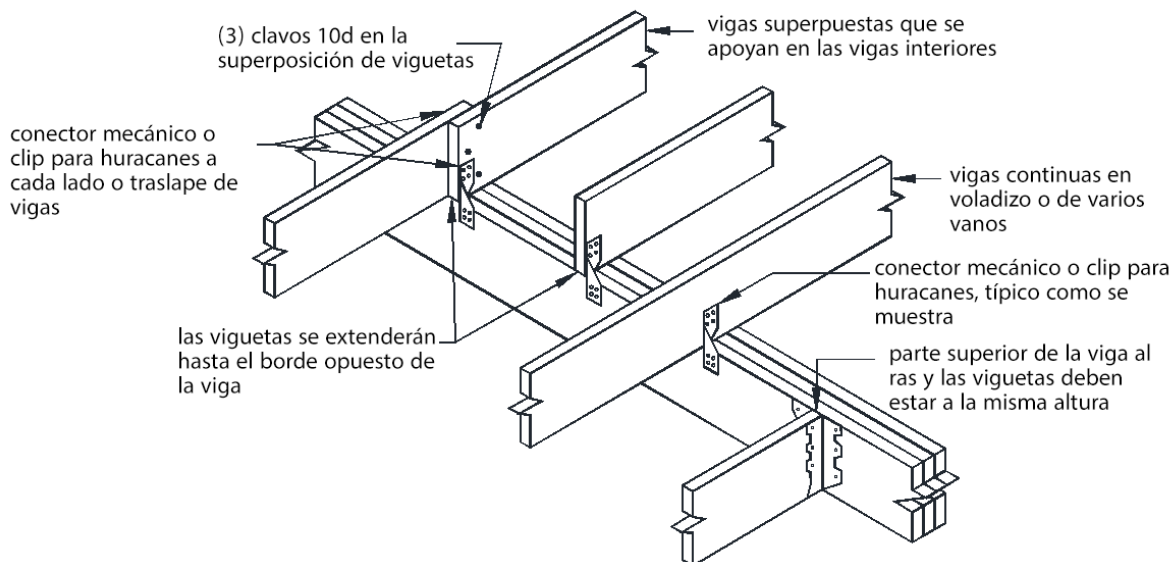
CONEXIÓN VIGUETA A VIGA
